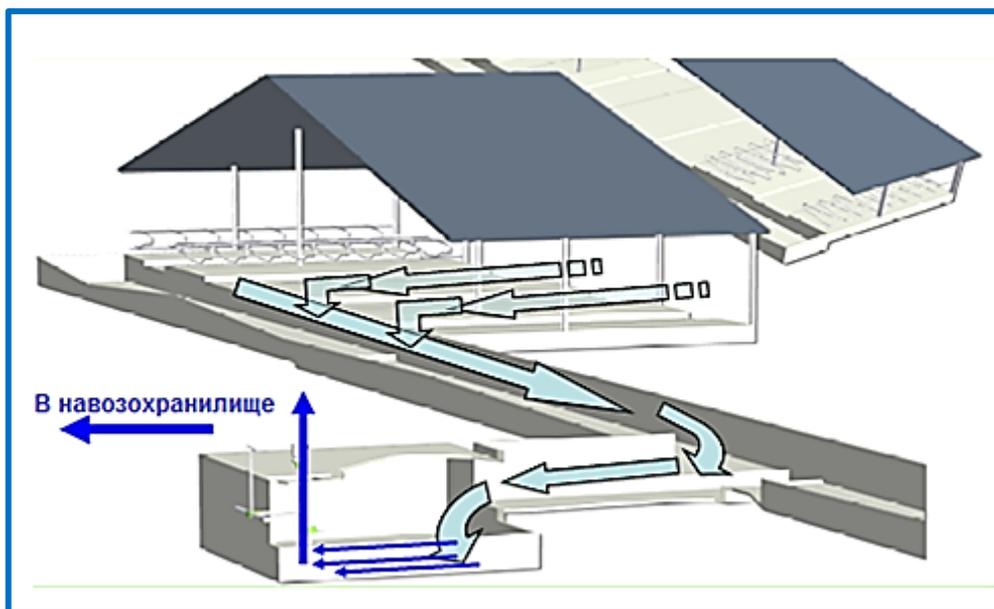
Схема уборки навоза в широкогабаритных коровниках
